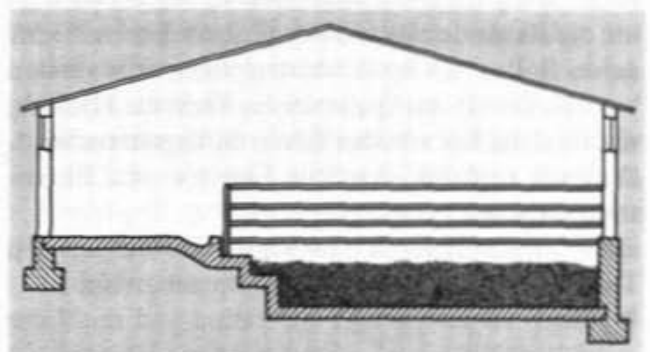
Querschnitt durch einen Tieflaufstall für Mastbullen.
